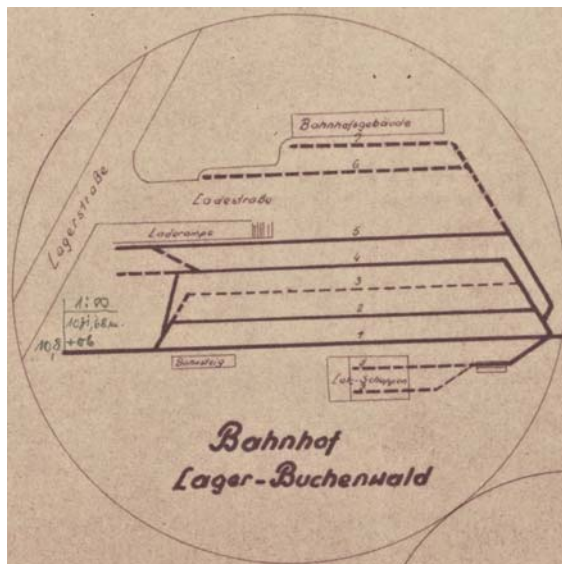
Plan des Bahnhof Buchenwald, 1943
